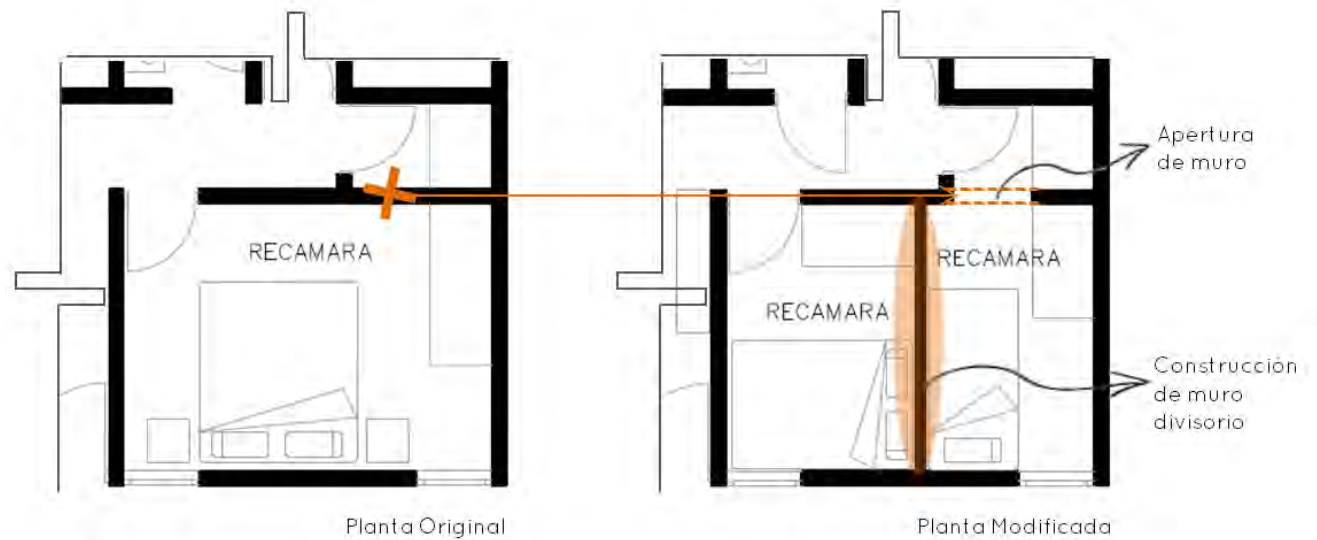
Planta actual comparada con la original, indicando los elementos que crearon la modificación en una de las recámaras.
